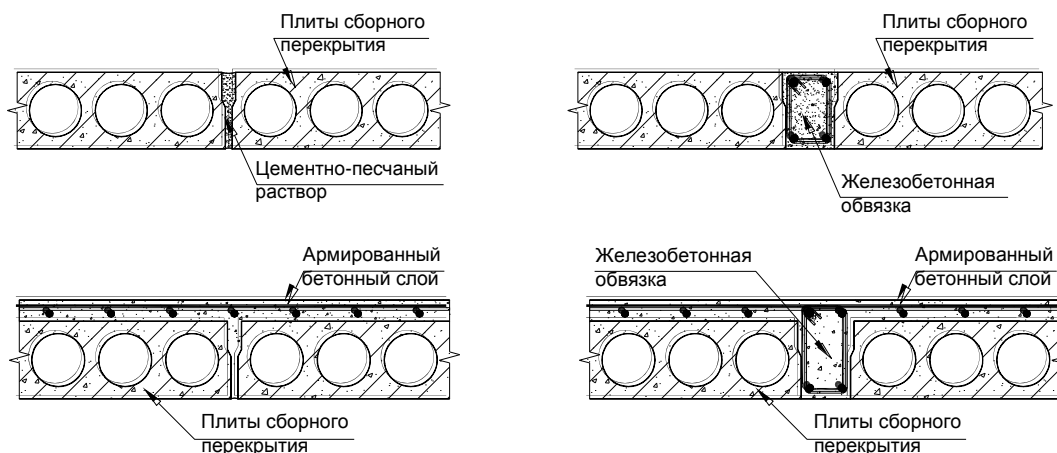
Примеры устройства железобетонных антисейсмических поясов в уровнях междуэтажных сборных перекрытий
